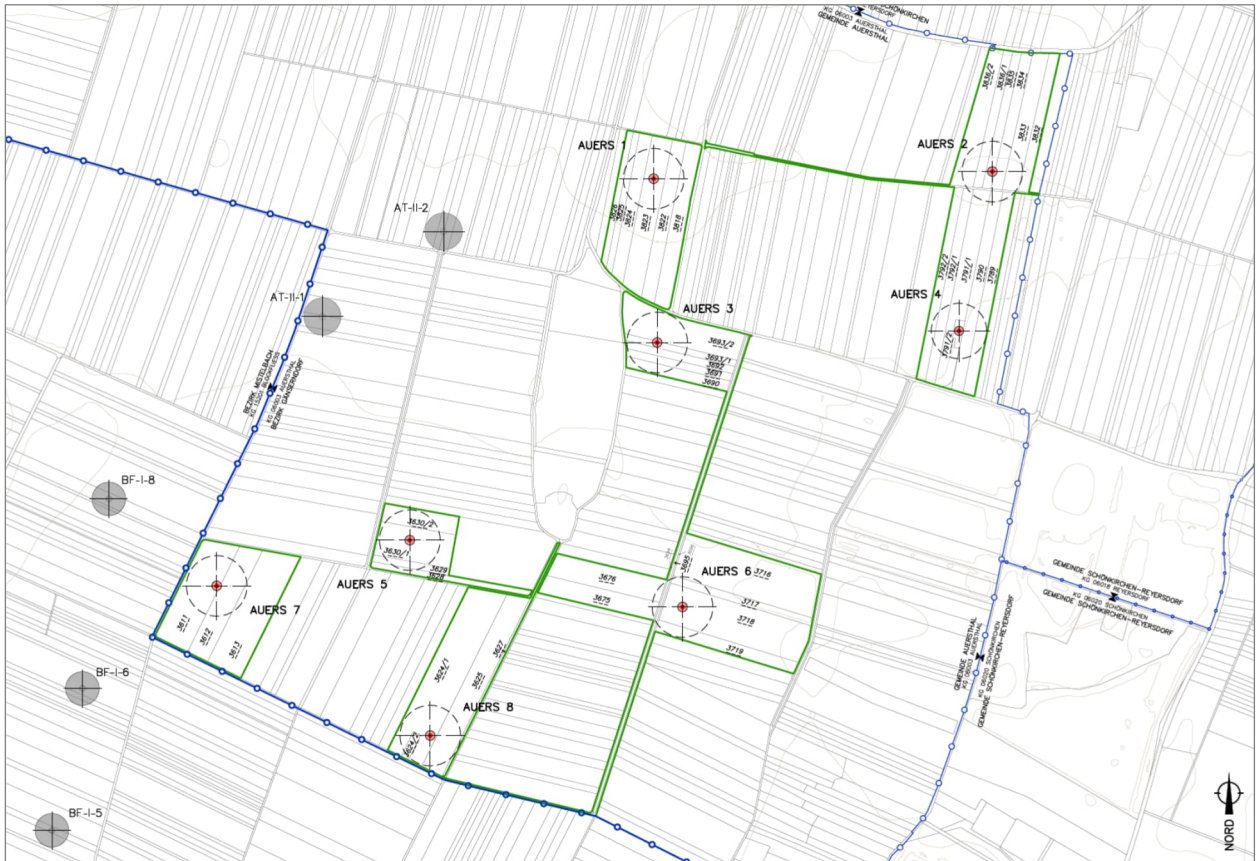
Lageplan mit Anlagenpositionen und berührten Grundstücken
